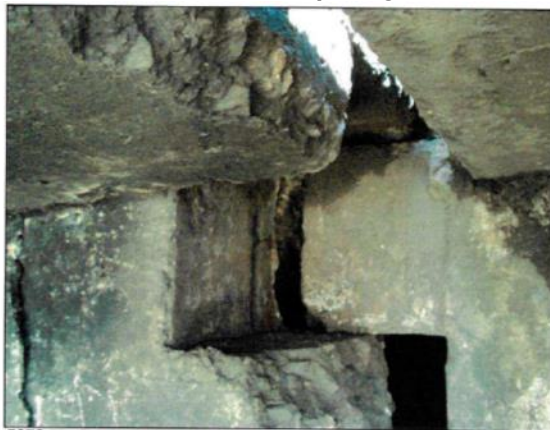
Detalhe do vão severo da junta de dilatação há movimento da parede do encontro, infiltrações, trincas, deslocamentos, com exposição de armadura e perda de concreto na parede do encontro.
